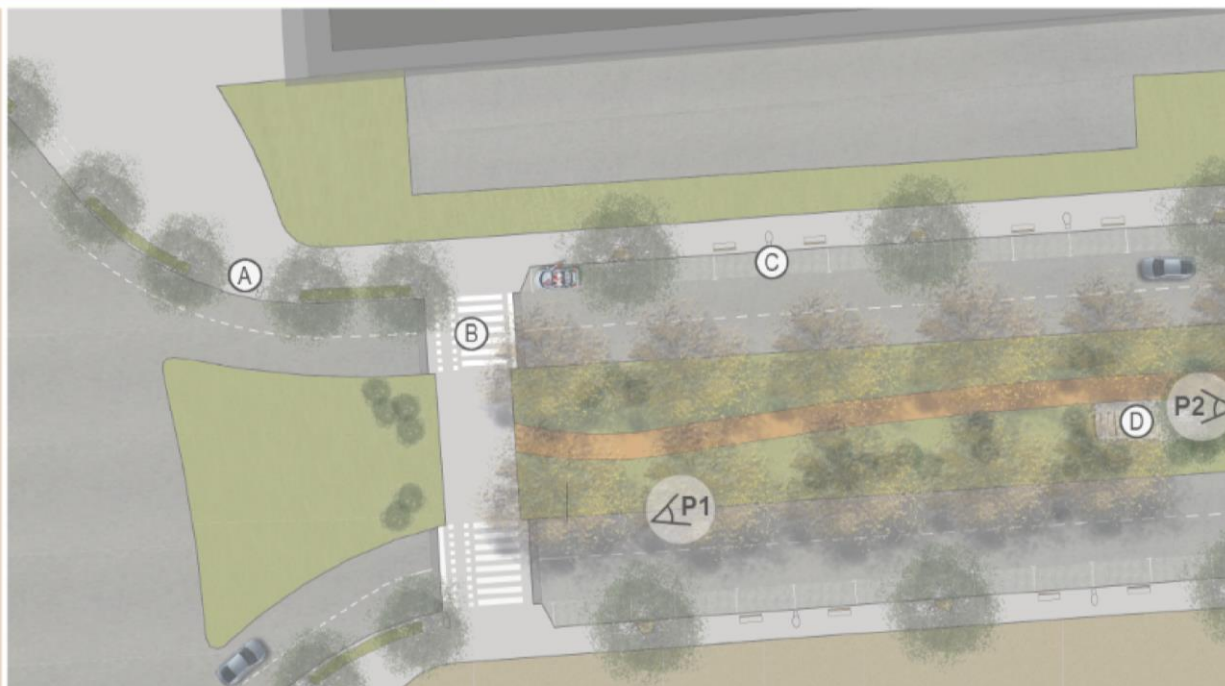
Ficha de proposta do troço 1.a. (Autor)
